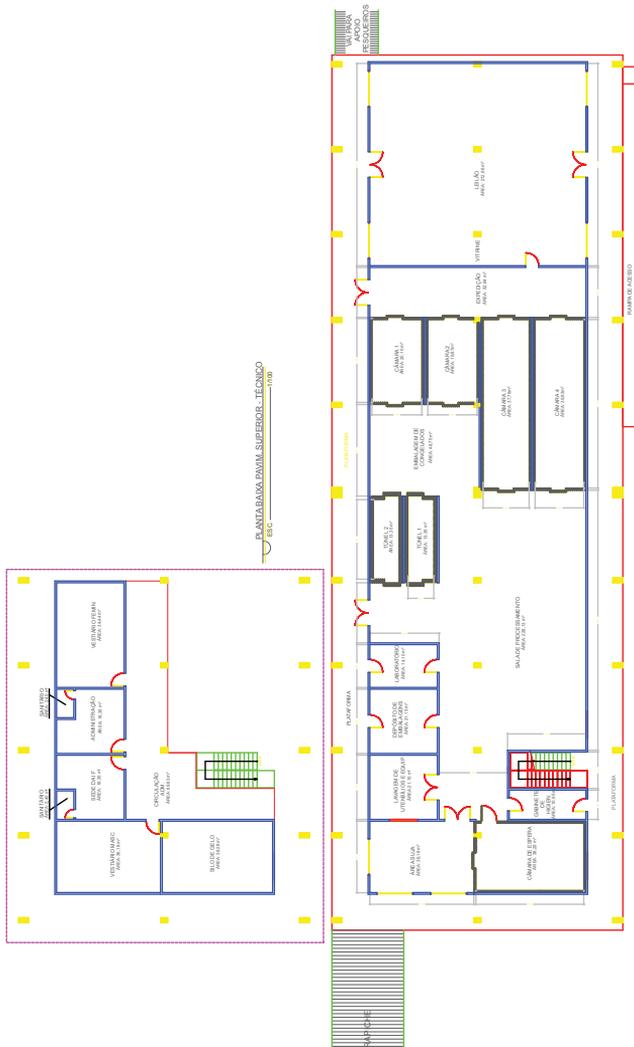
Planta baixa do bloco industrial – Bloco 02
